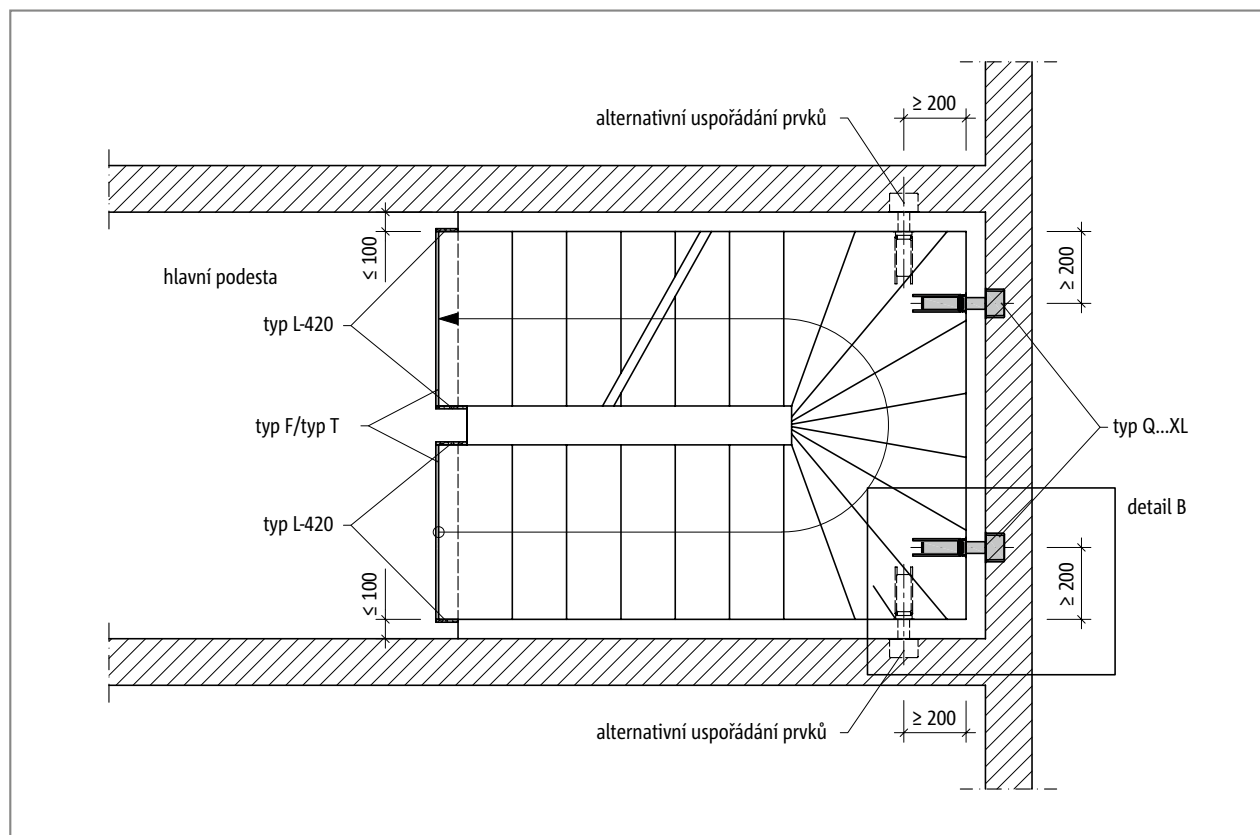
Schöck Tronsole® typ Q: Půdorysné uspořádání prvků při užití spárových desek Tronsole® typ L
